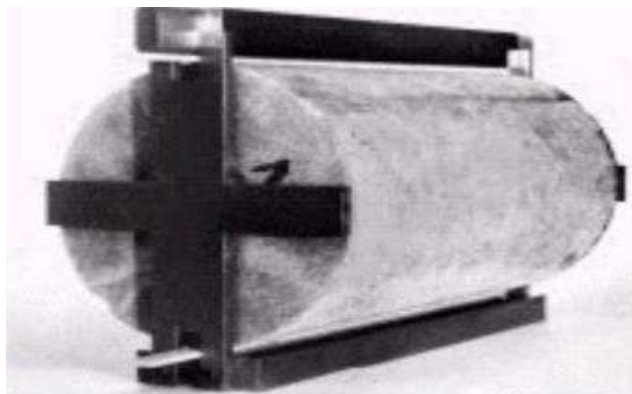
Guías para alinear los cilindros de concreto y las franjas de apoyo. [50]
